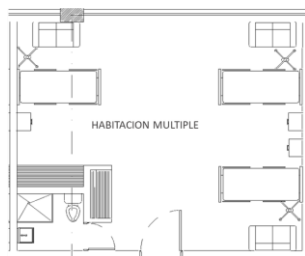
Planta habitación múltiple – Fuente: Elaboración propia
